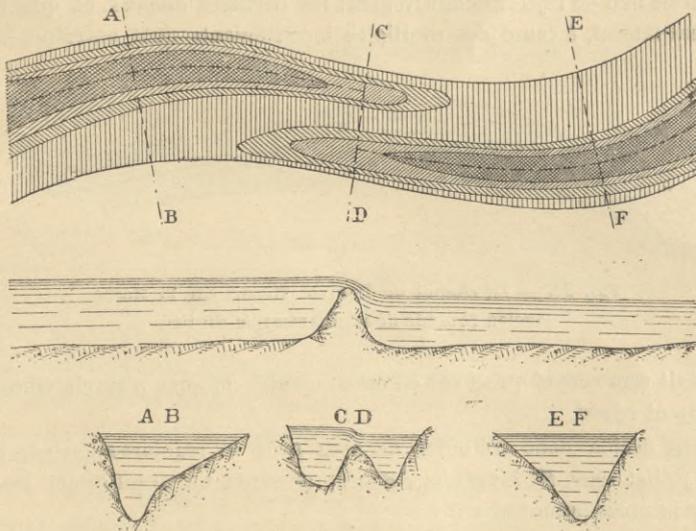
, 24 et 25. — Plan, profil en long et profils en travers d'un mauvais passage.
